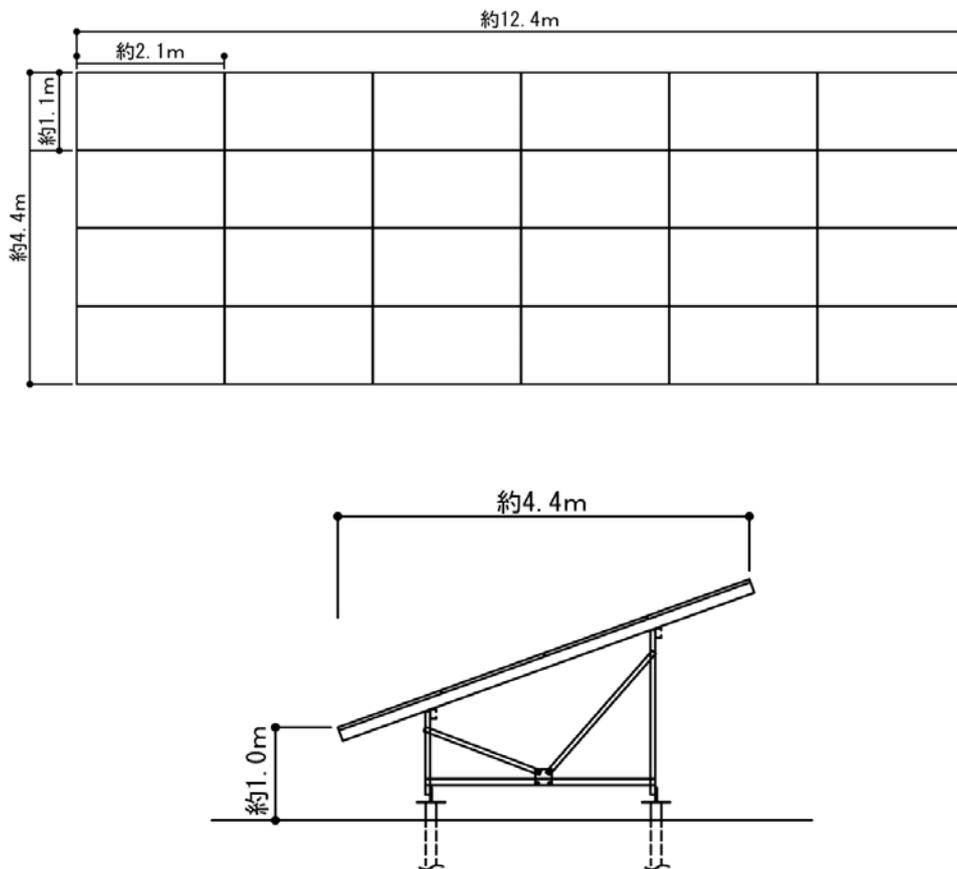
太陽光パネル（アレイ）平面図及び架台断面図（例）
